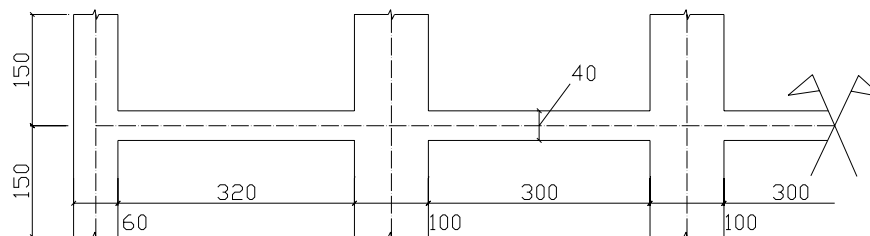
Geometria da viga, Caso 3 (dimensões em cm)
